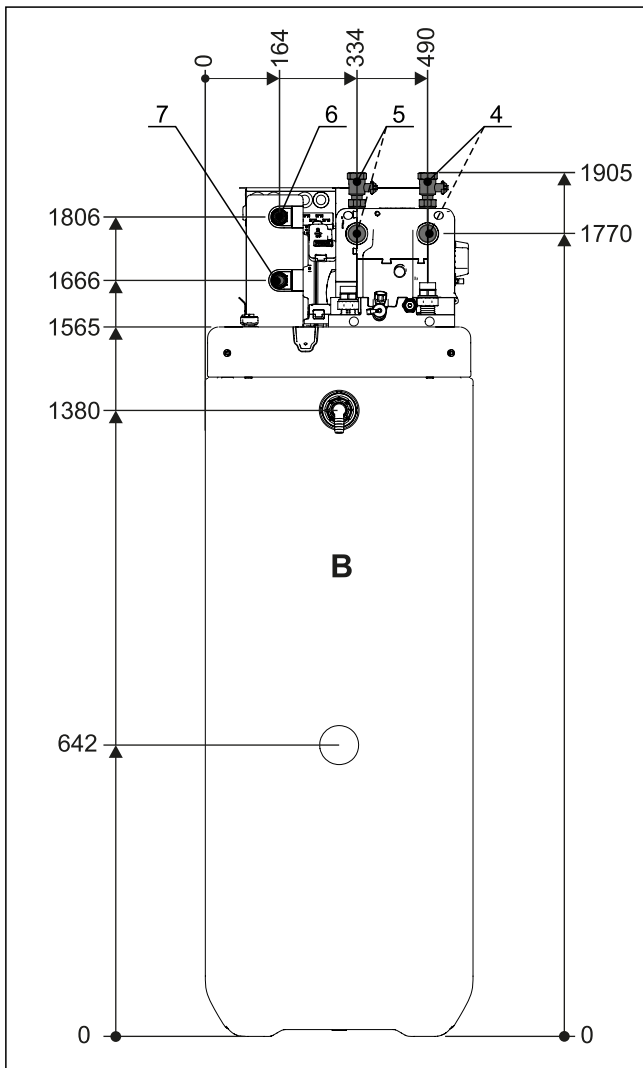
Abmessungen Seitenansicht - ETS(X/H)B16P30D
